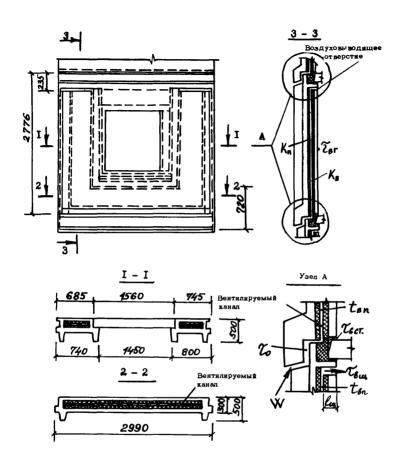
I. Трехслойная керамзитобетонная (вентилируемая) панель и ее горизонтальный стык
